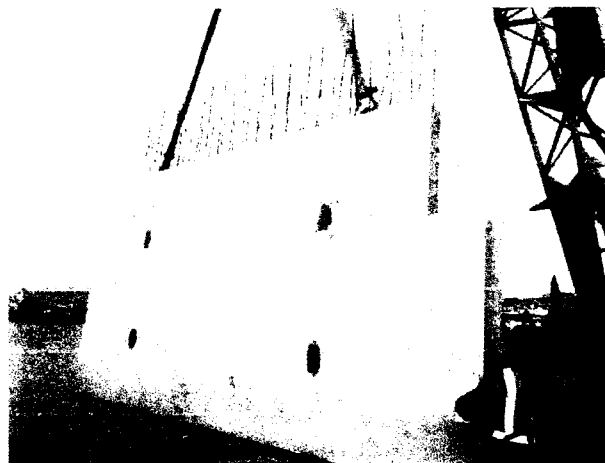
Transporte y colocación de losa y Vigas mandiles, obras de mar.
